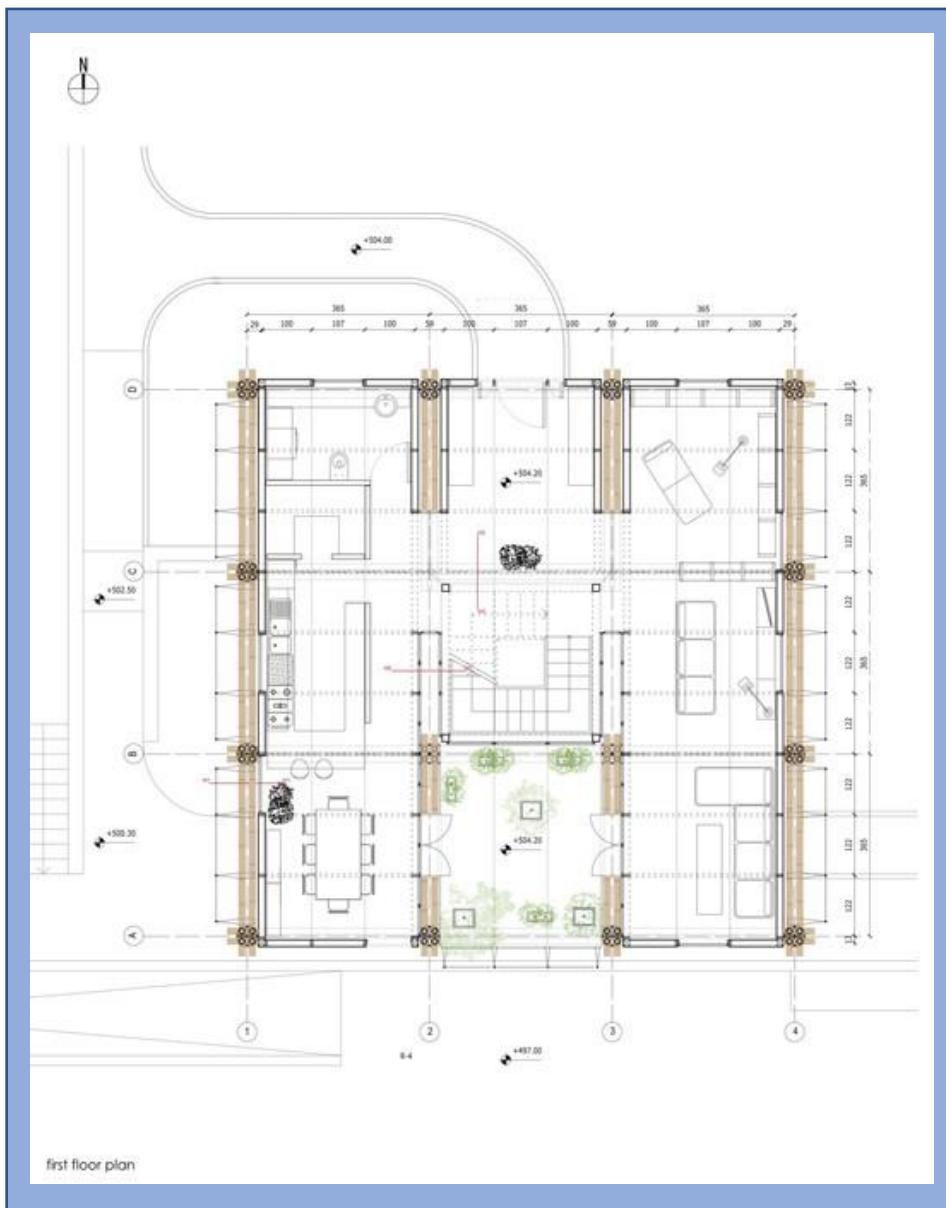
fuente Plataforma Arquitectura, Planta del Primer Piso
